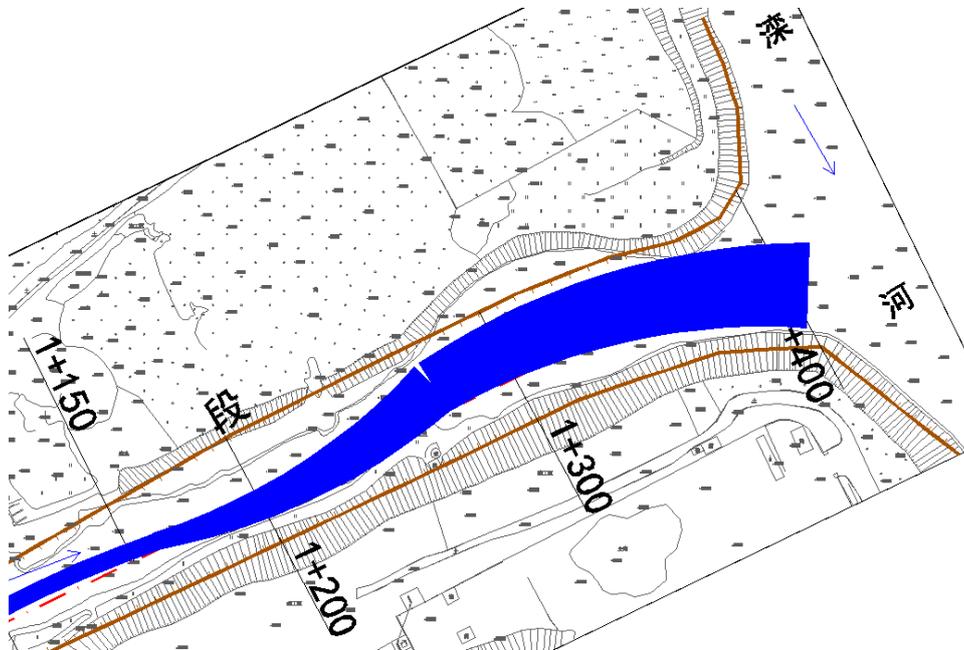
1+085 至 1+400 河道清淤疏浚平面布置图
